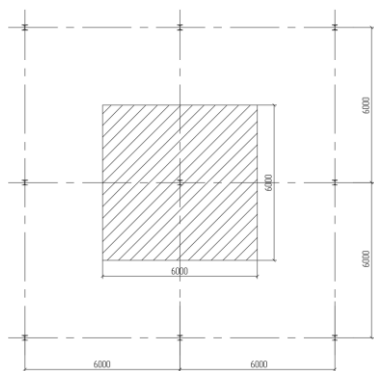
Схема сбора нагрузок с перекрытий и покрытий
